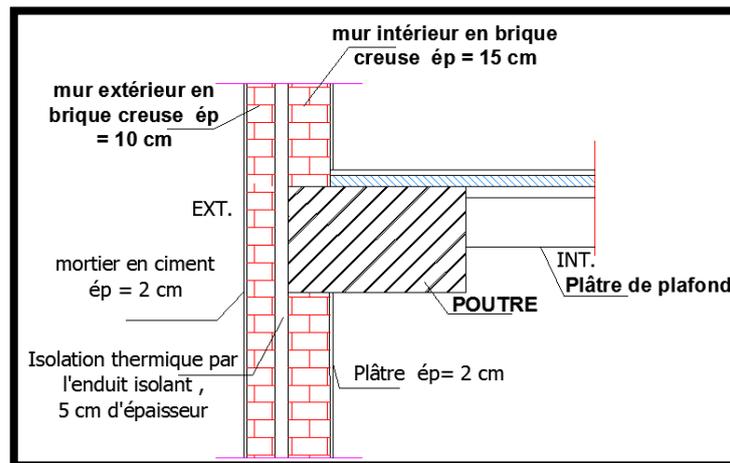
Coupe montre le traitement de ponts thermique, source: (Auteur, 2021)
